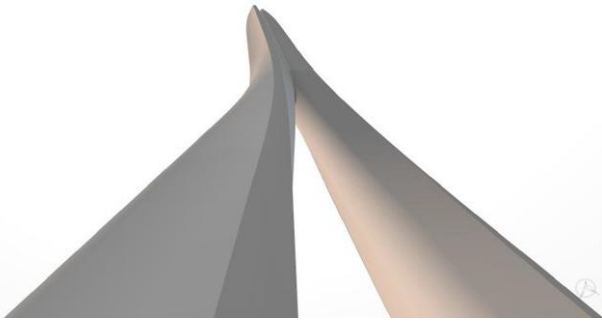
Punto de vista en la plataforma situada debajo del pilón del puente
